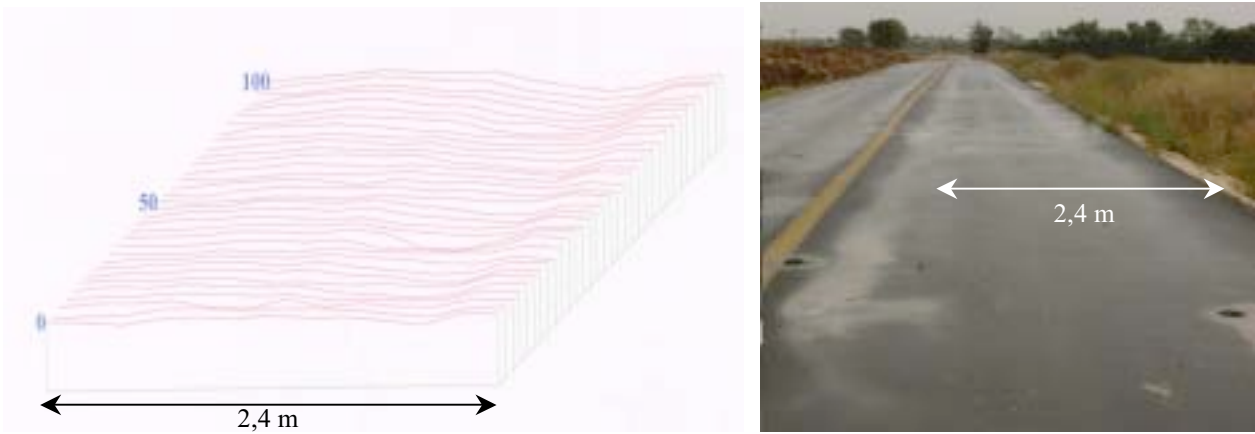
Représentation en 3D de l'orniérage de la chaussée d'après les mesures réalisées lors d'un passage du TUS et photographie de la chaussée déformée.
